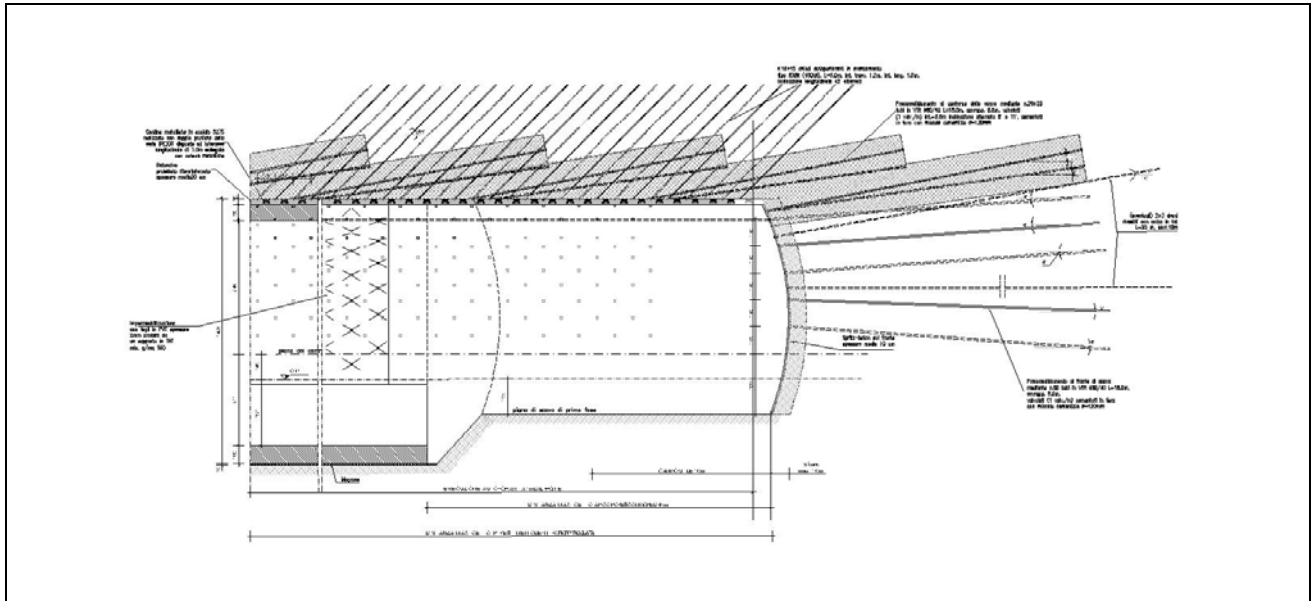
Sezione di scavo tipo GD-PS-B – PIAZZOLA DI SOSTA - Sezione longitudinale
